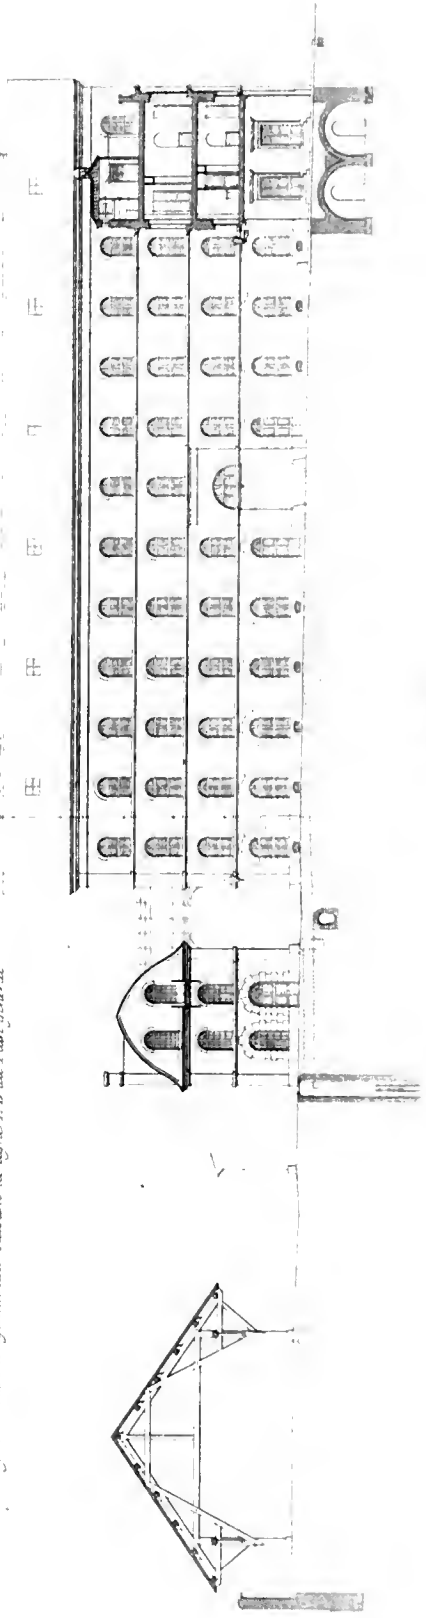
Coupe transversale suivant la ligne C D E G H du plan général.
